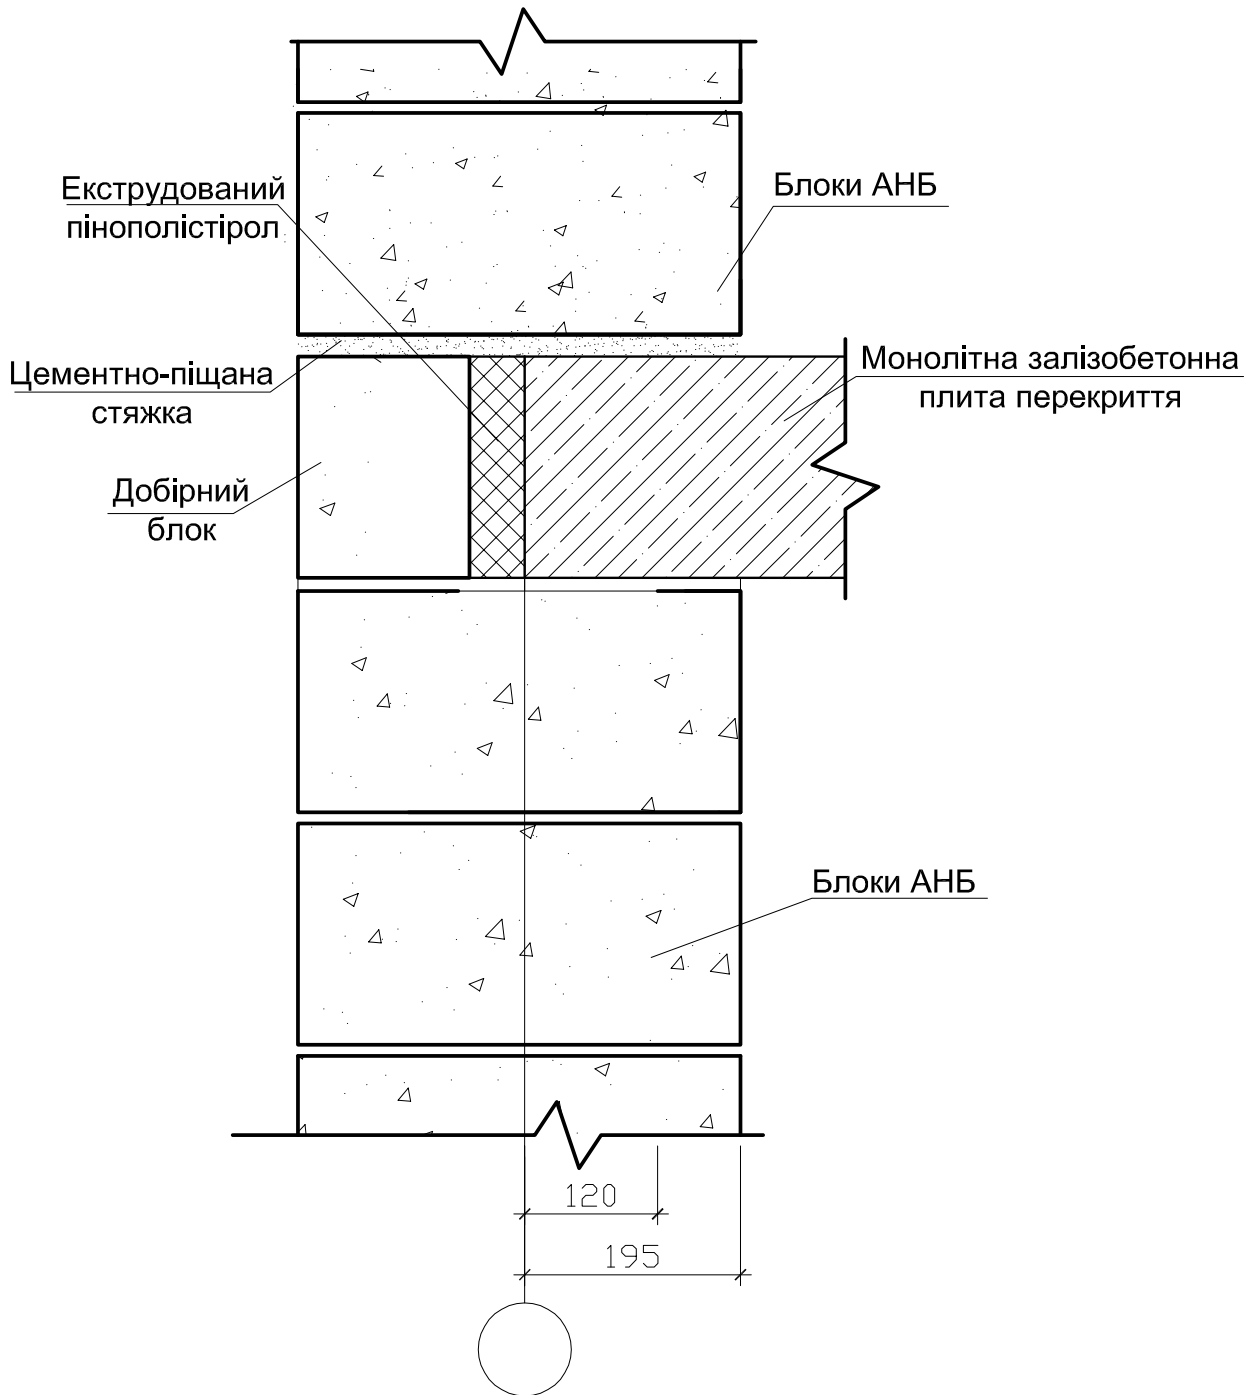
8-2. Спирання монолітного залізобетонного перекриття на зовнішню стіну з АНБ
